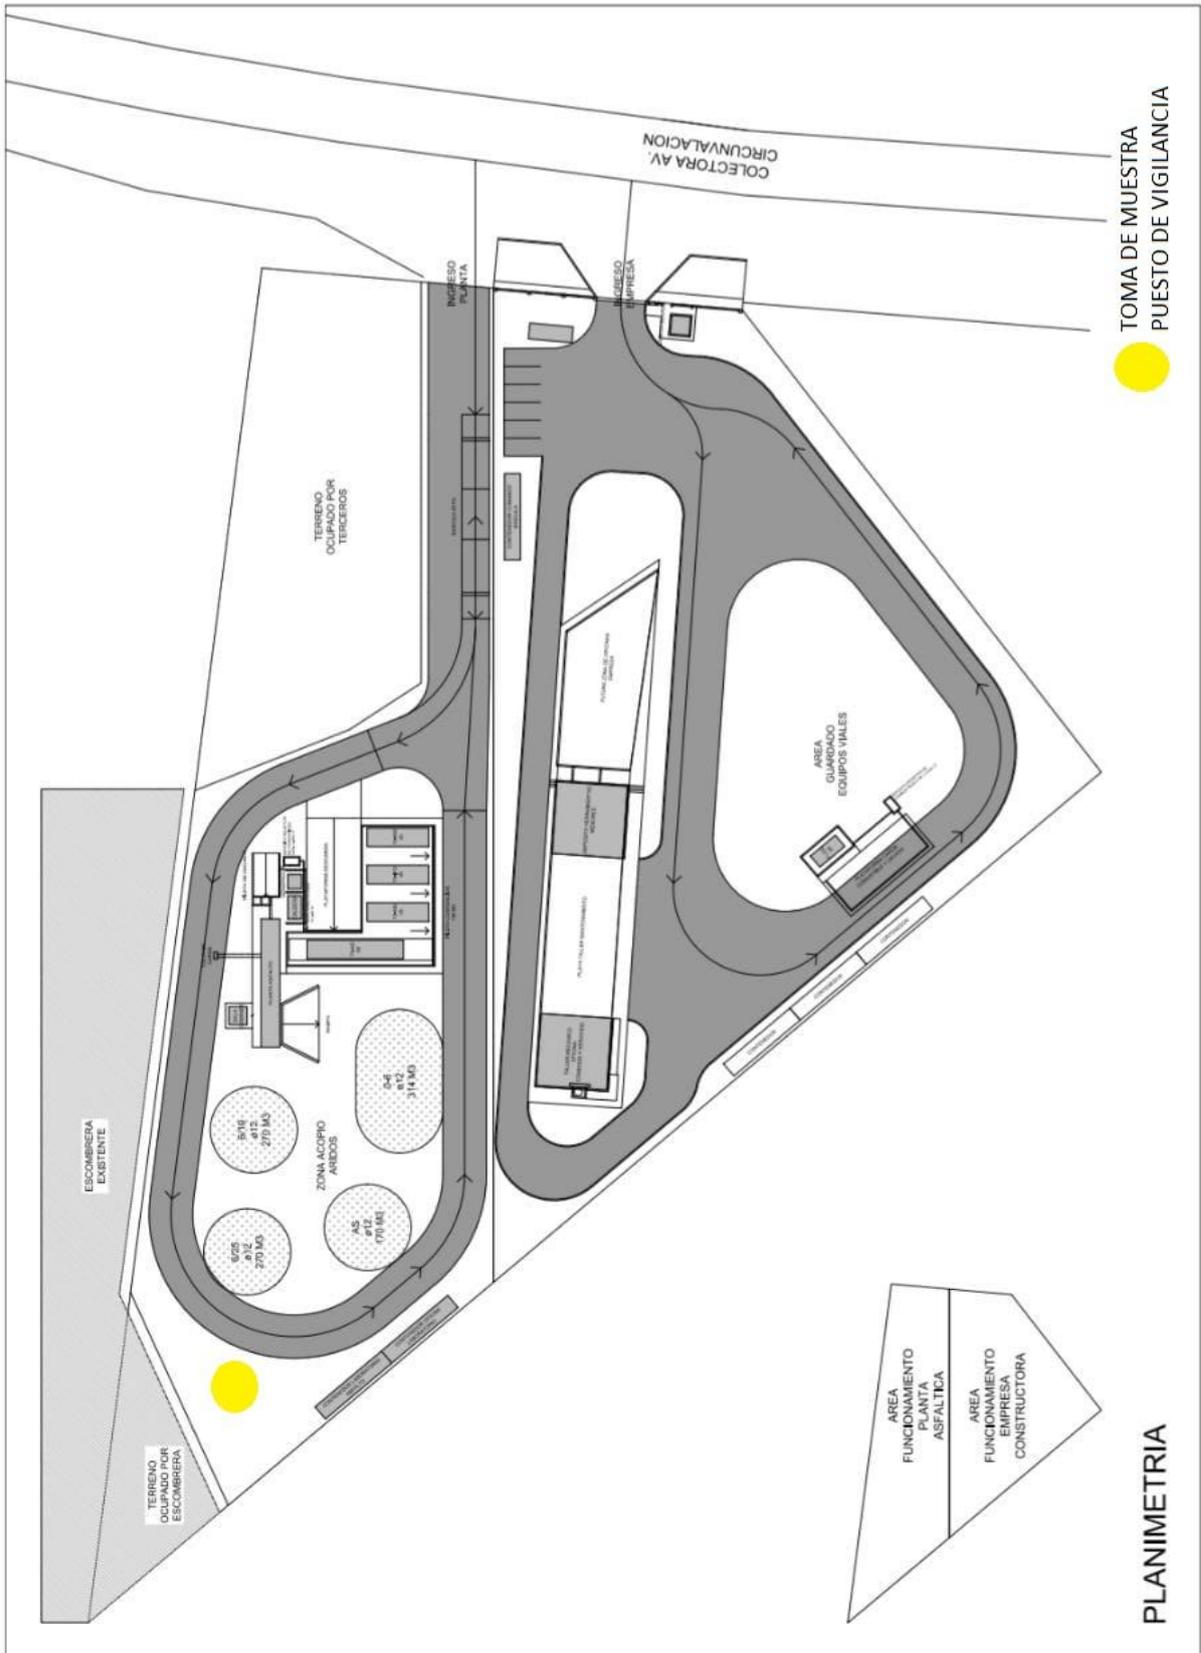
Plano Toma de Muestra. Sector planta de asfalto. Protocolo 861/15
